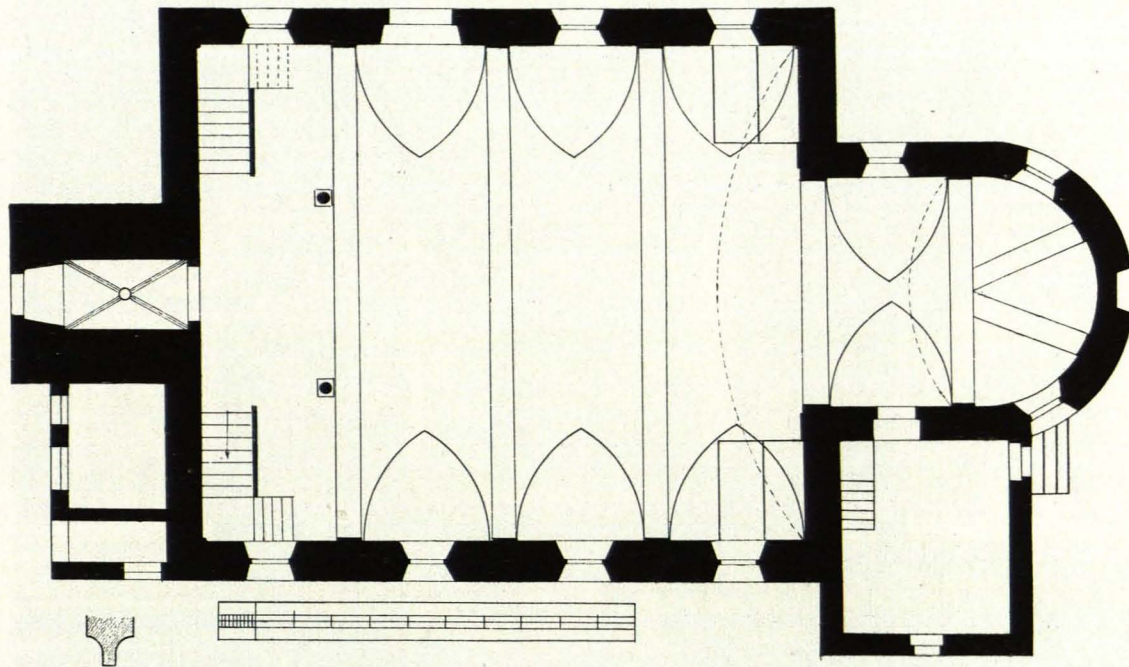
Hallwang, Pfarrkirche, Grundriß 1:200 (S. 159)
